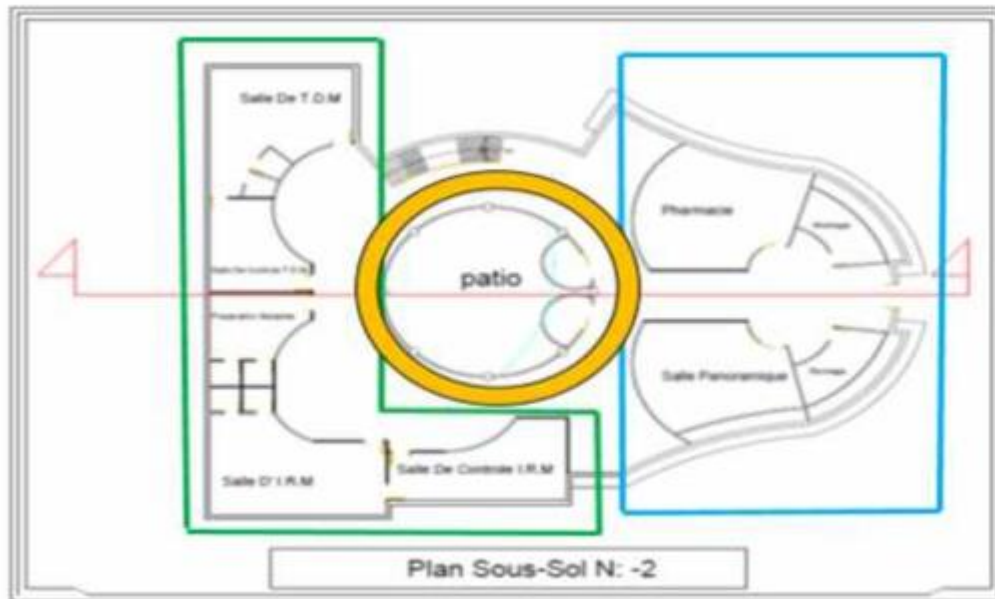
Plan Sous-Sol niveau : -2. Source : auteur
